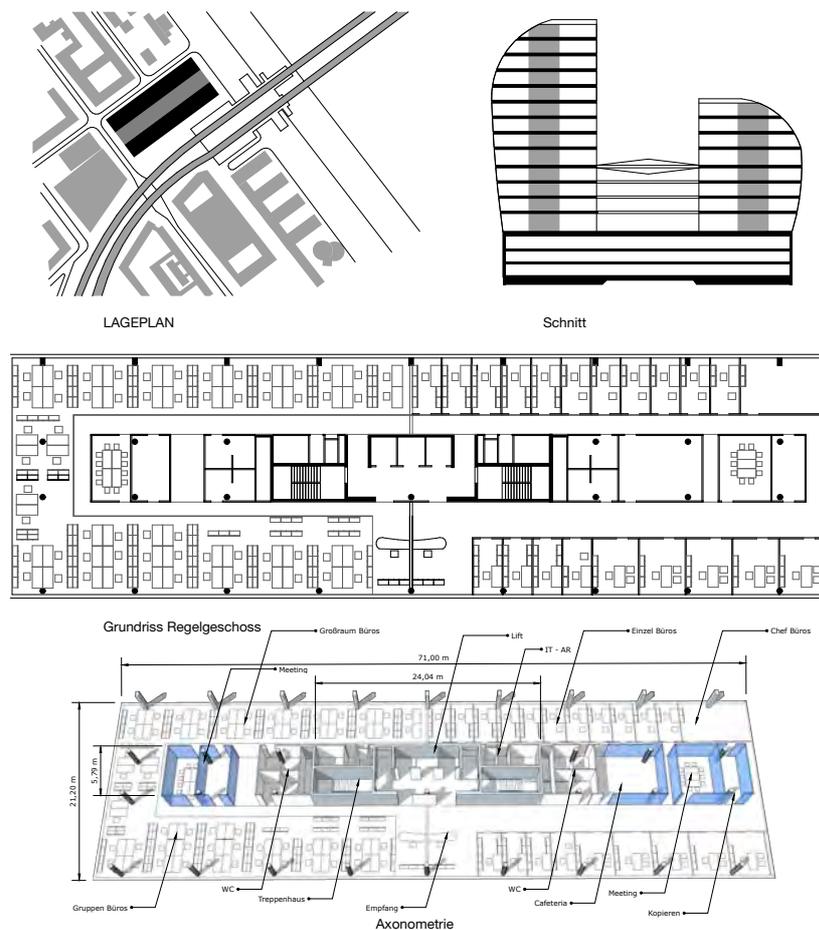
Bürogebäude - Rivergate Wien; Arch.: BDA und Partner; Wien (AUT)
